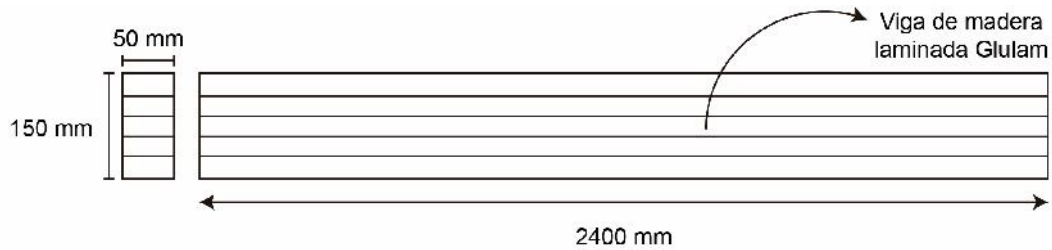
Dimensiones de las vigas de madera laminada Glulam
